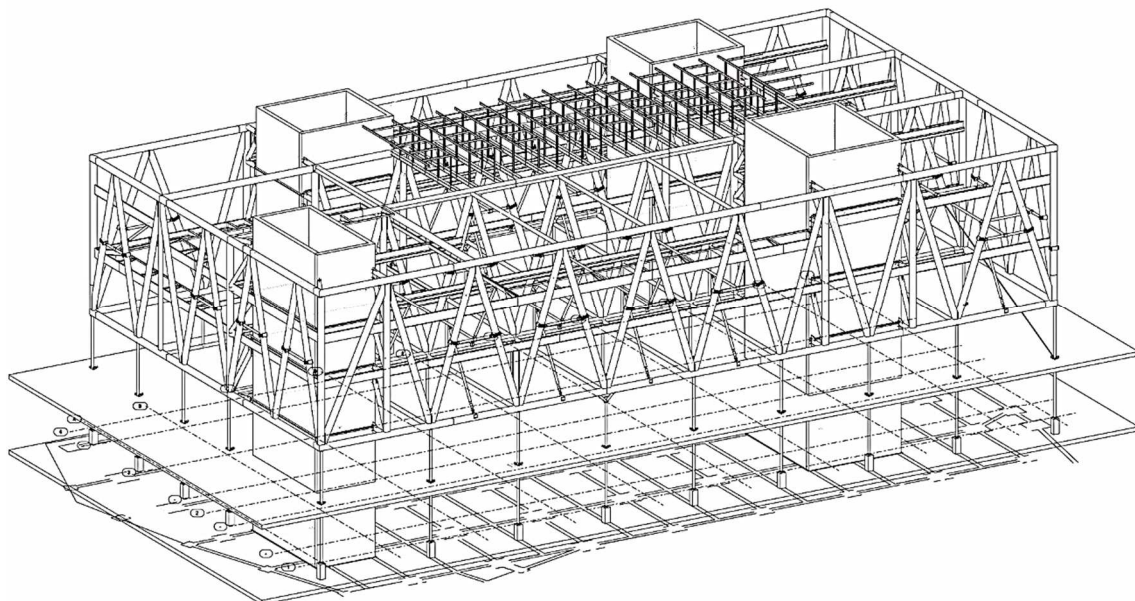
Vista 3D del proceso de montaje de la estructura metálica de la caja operativa. (Imagen propia del TEKLA)
